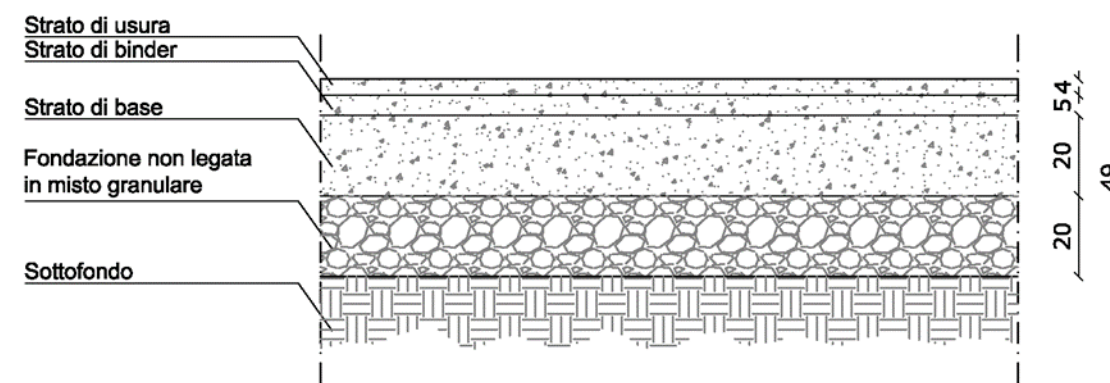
Sezione trasversale tipica del collegamento a via del Paleotto
